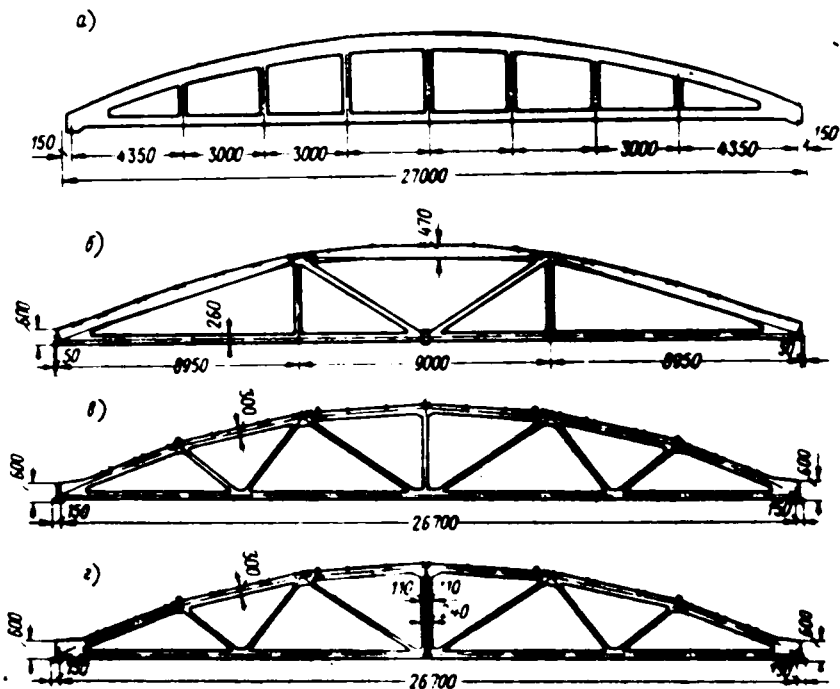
Предварительно напряженные фермы пролетом 27 м с пучковой арматурой (варианты разработки 1955—1956 гг.)
